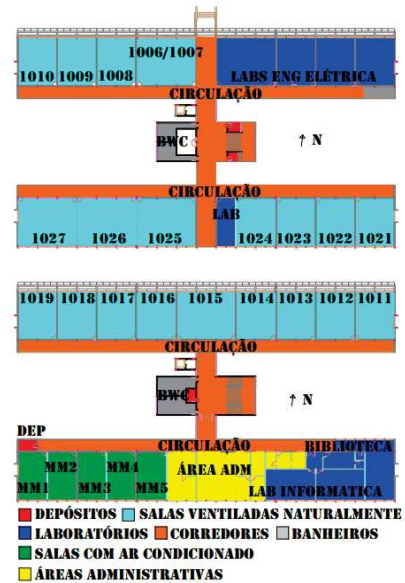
Planta baixa esquematizada do térreo e primeiro pavimento do CTU
